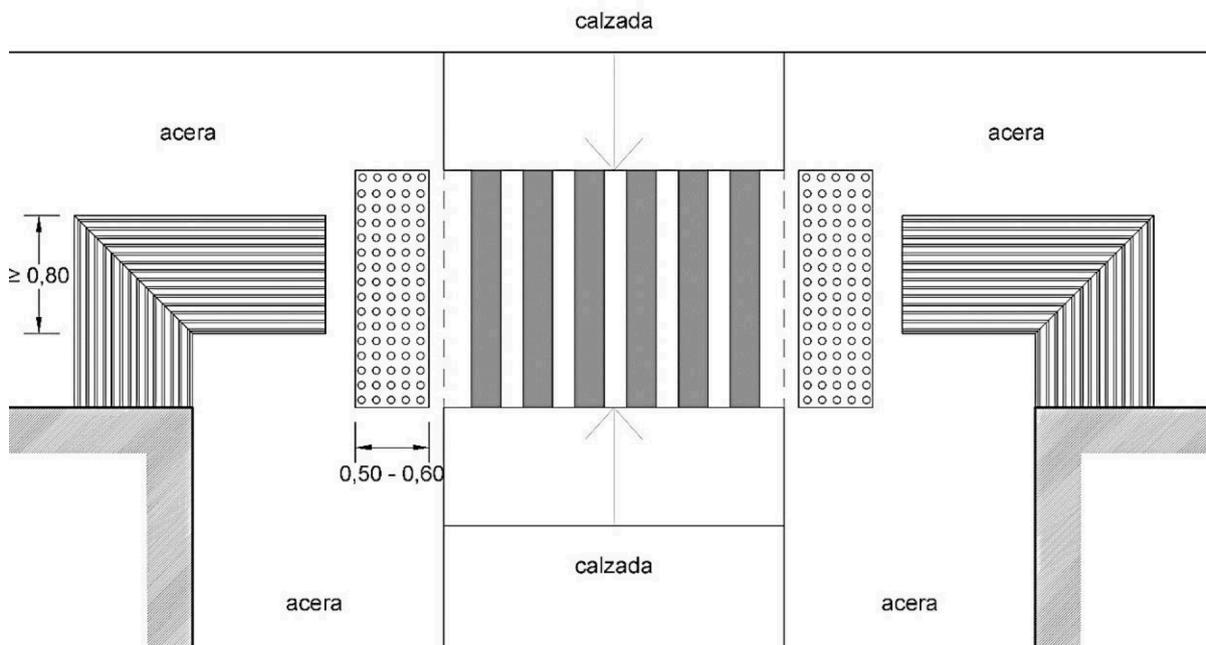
11. Ejemplo de cruce entre acera y calzada elevada que atraviesa la acera
